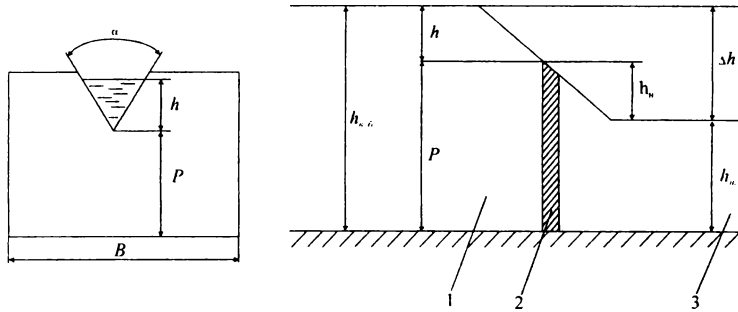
Схема треугольного водослива с тонкой стенкой:
